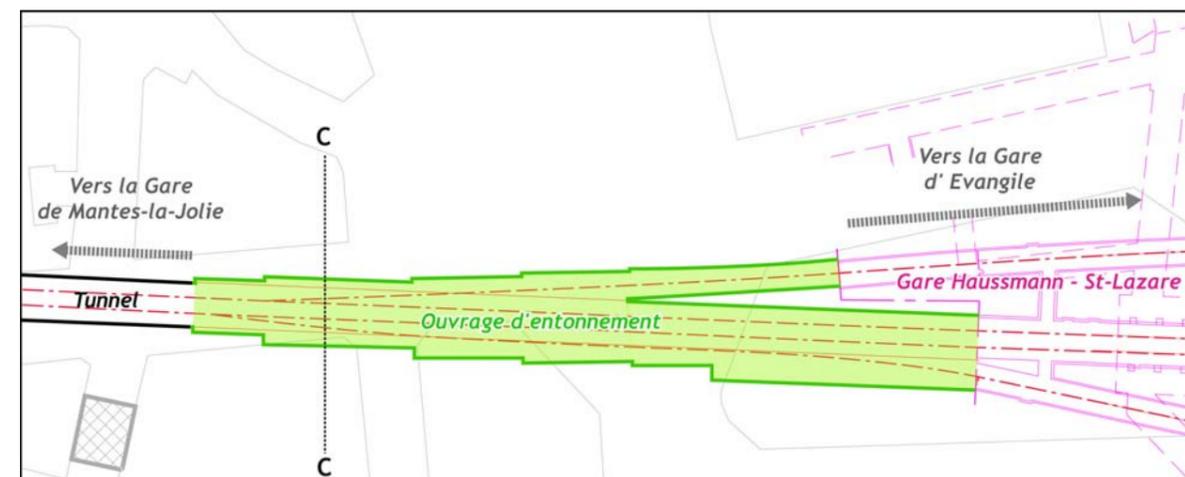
Vue en plan de l'ouvrage d'entonnement raccordant les voies d'Haussmann-Saint-Lazare au tunnel
